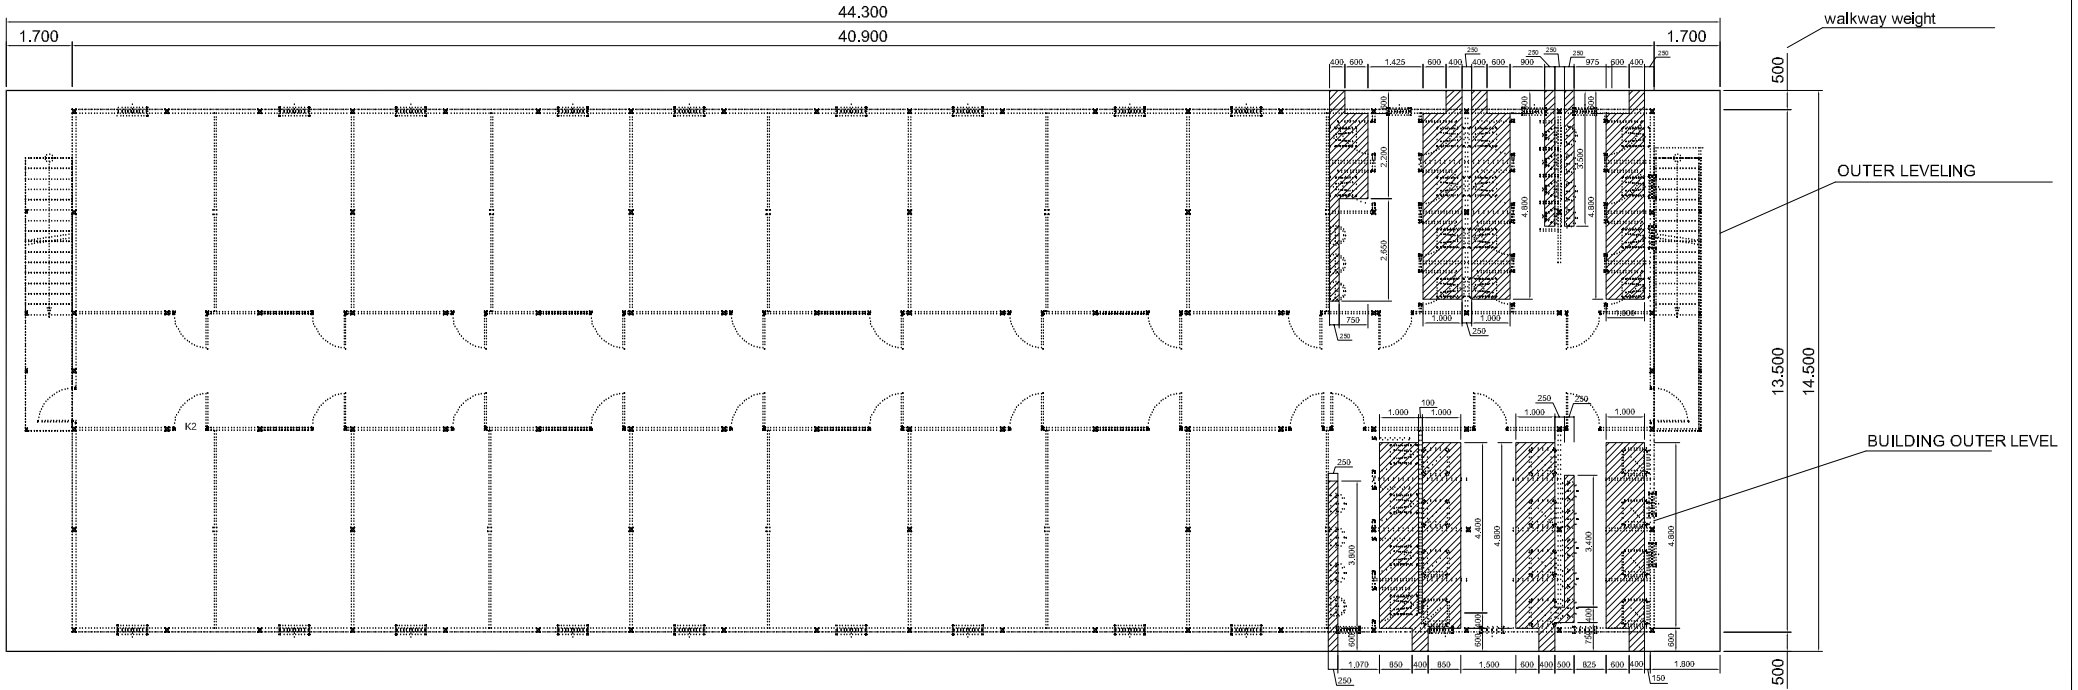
Zemin Hazırlık ve Beton İşleri (Prefi tarafından beton planı verilmektedir)
